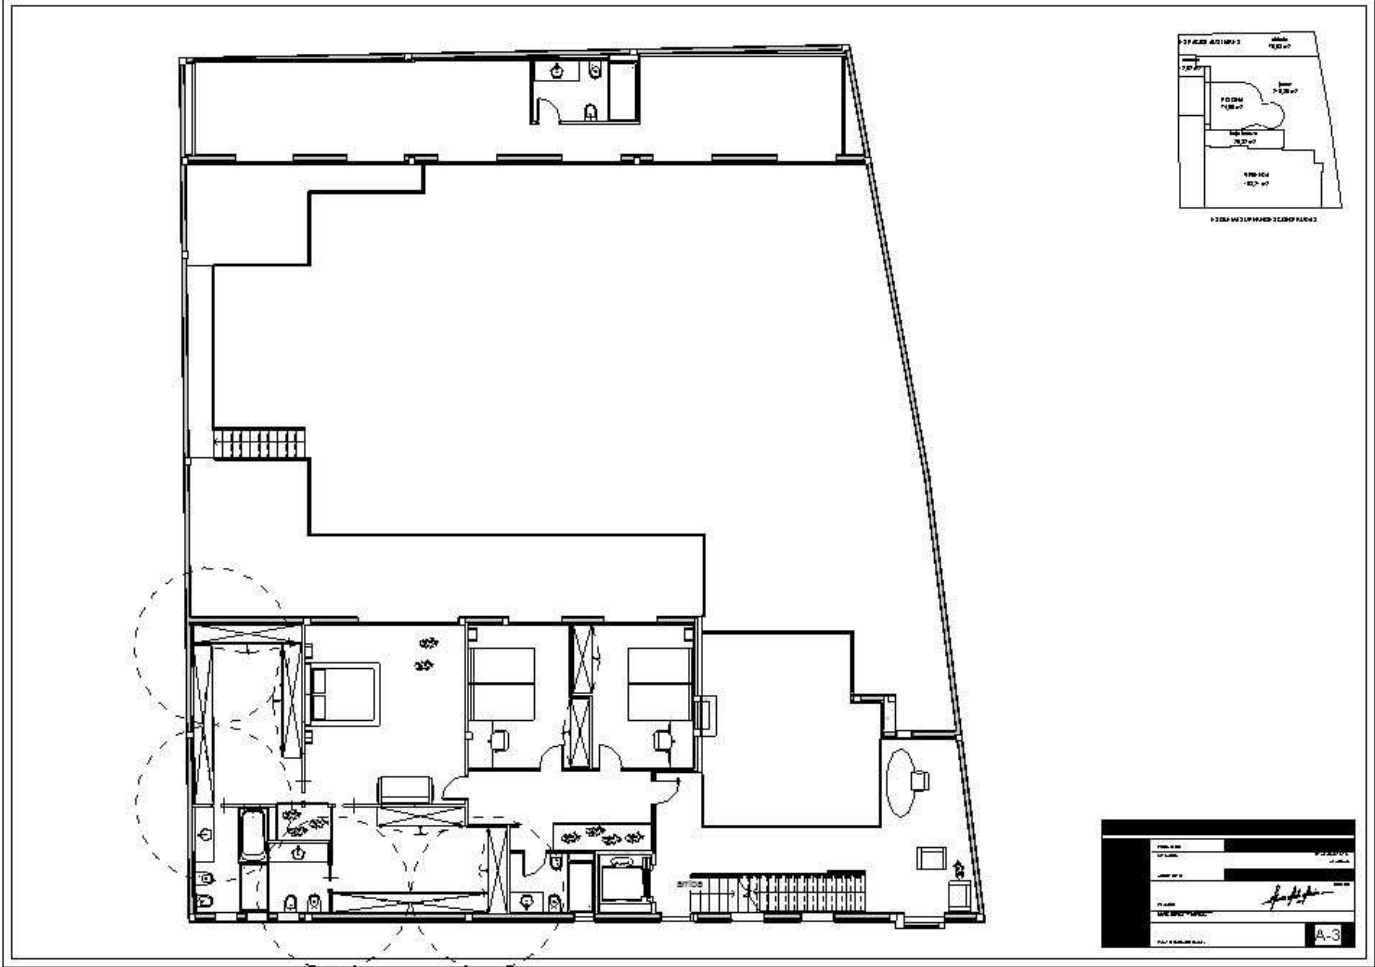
Plano Arquitectónico A-3. Planta Primera. Fuente propia. 2016
